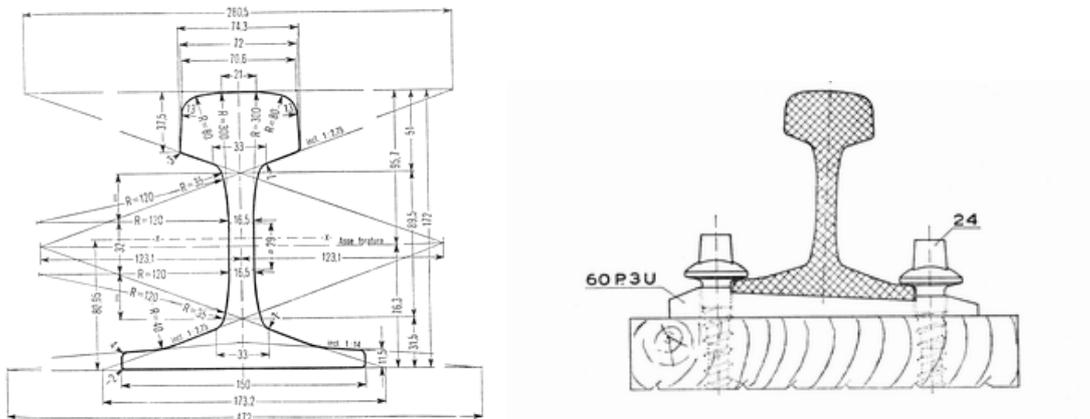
Sezione geometrica di un profilo tipo UNI 60 e particolare del raccordo alla traversa
